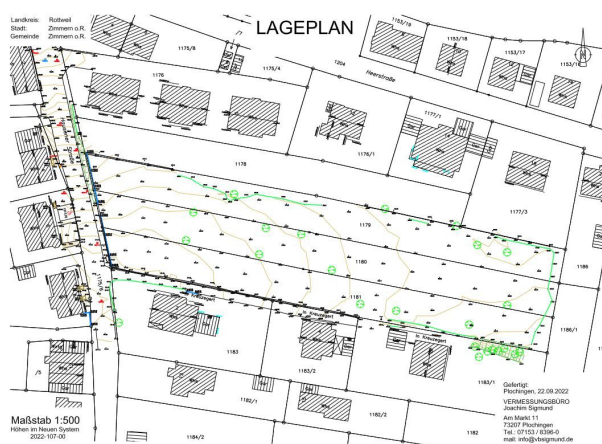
Lageplan mit Gehölzstandorten (Quelle: Vermessungsbüro Joachim Sigmund, Am Markt 11, 73207 Plochingen)
